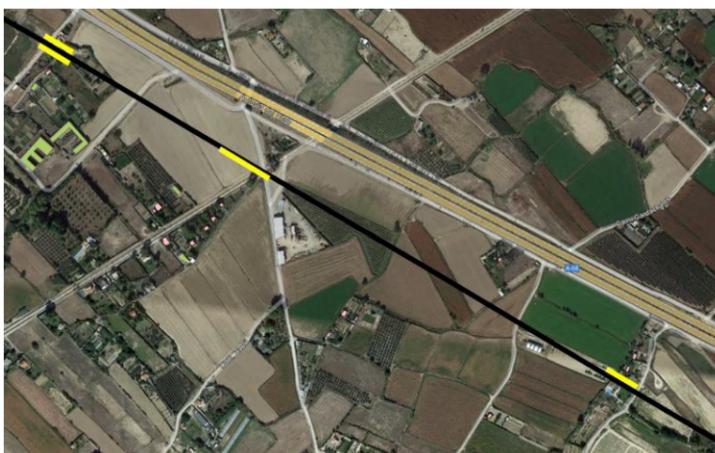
Ubicación de Pantallas acústicas en la Alternativa 2 Norte de la Conexión 2-3
